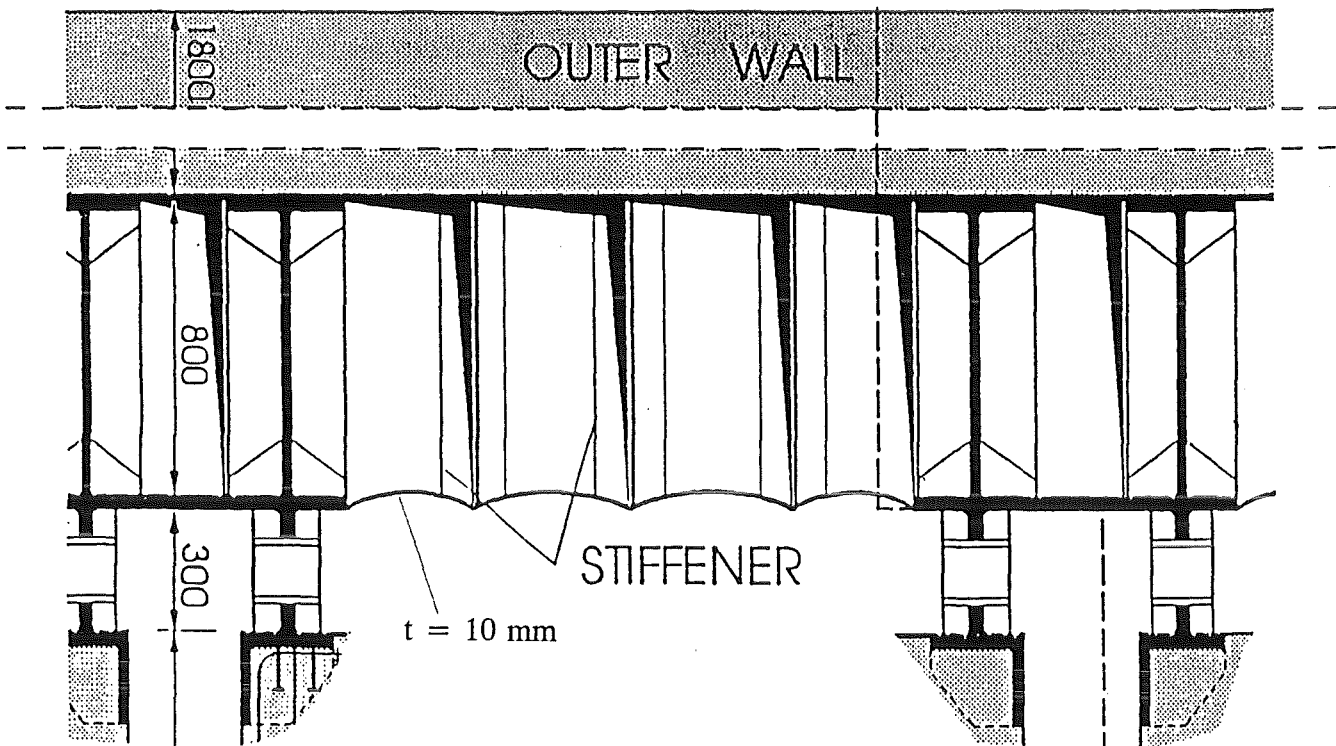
Draufsicht Stahlkühlzellen mit Liner
